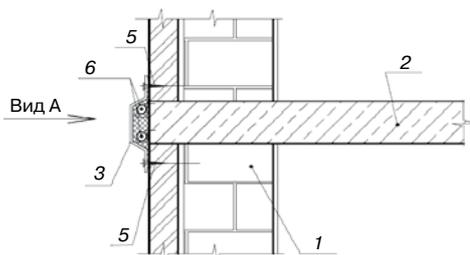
Устройство для утепления наружной стены здания трапециевидальной формы
